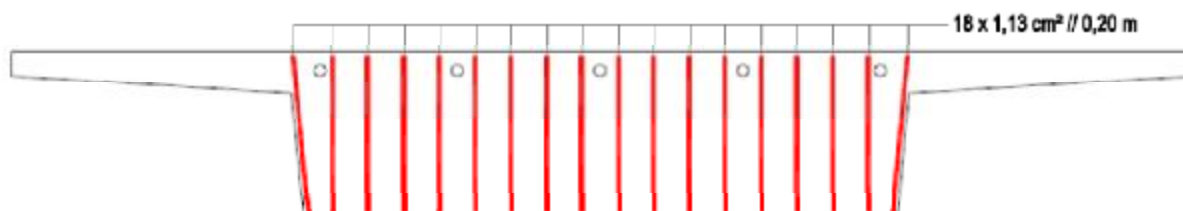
Esquematização das armaduras de esforço transversal do tabuleiro na zona maciça junto aos apoios
